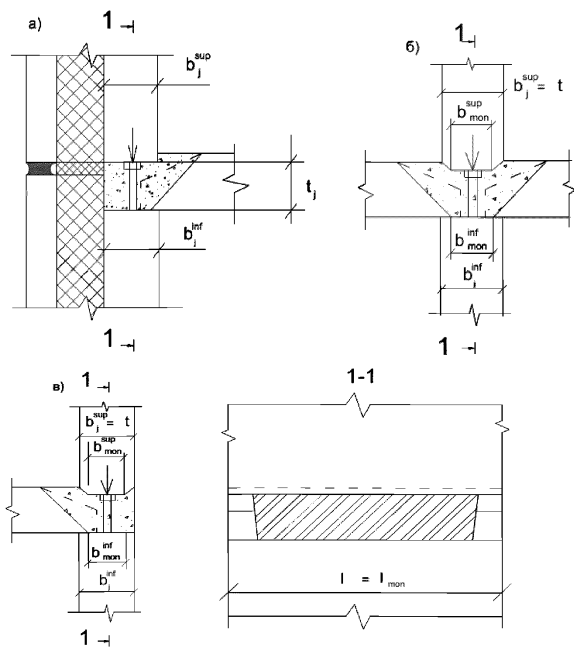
Монолитные стыки: а – наружные трехслойные стены; б – внутренние стены при двухстороннем опирании плит перекрытий; в – внутренние стены при одностороннем опирании плит перекрытий
